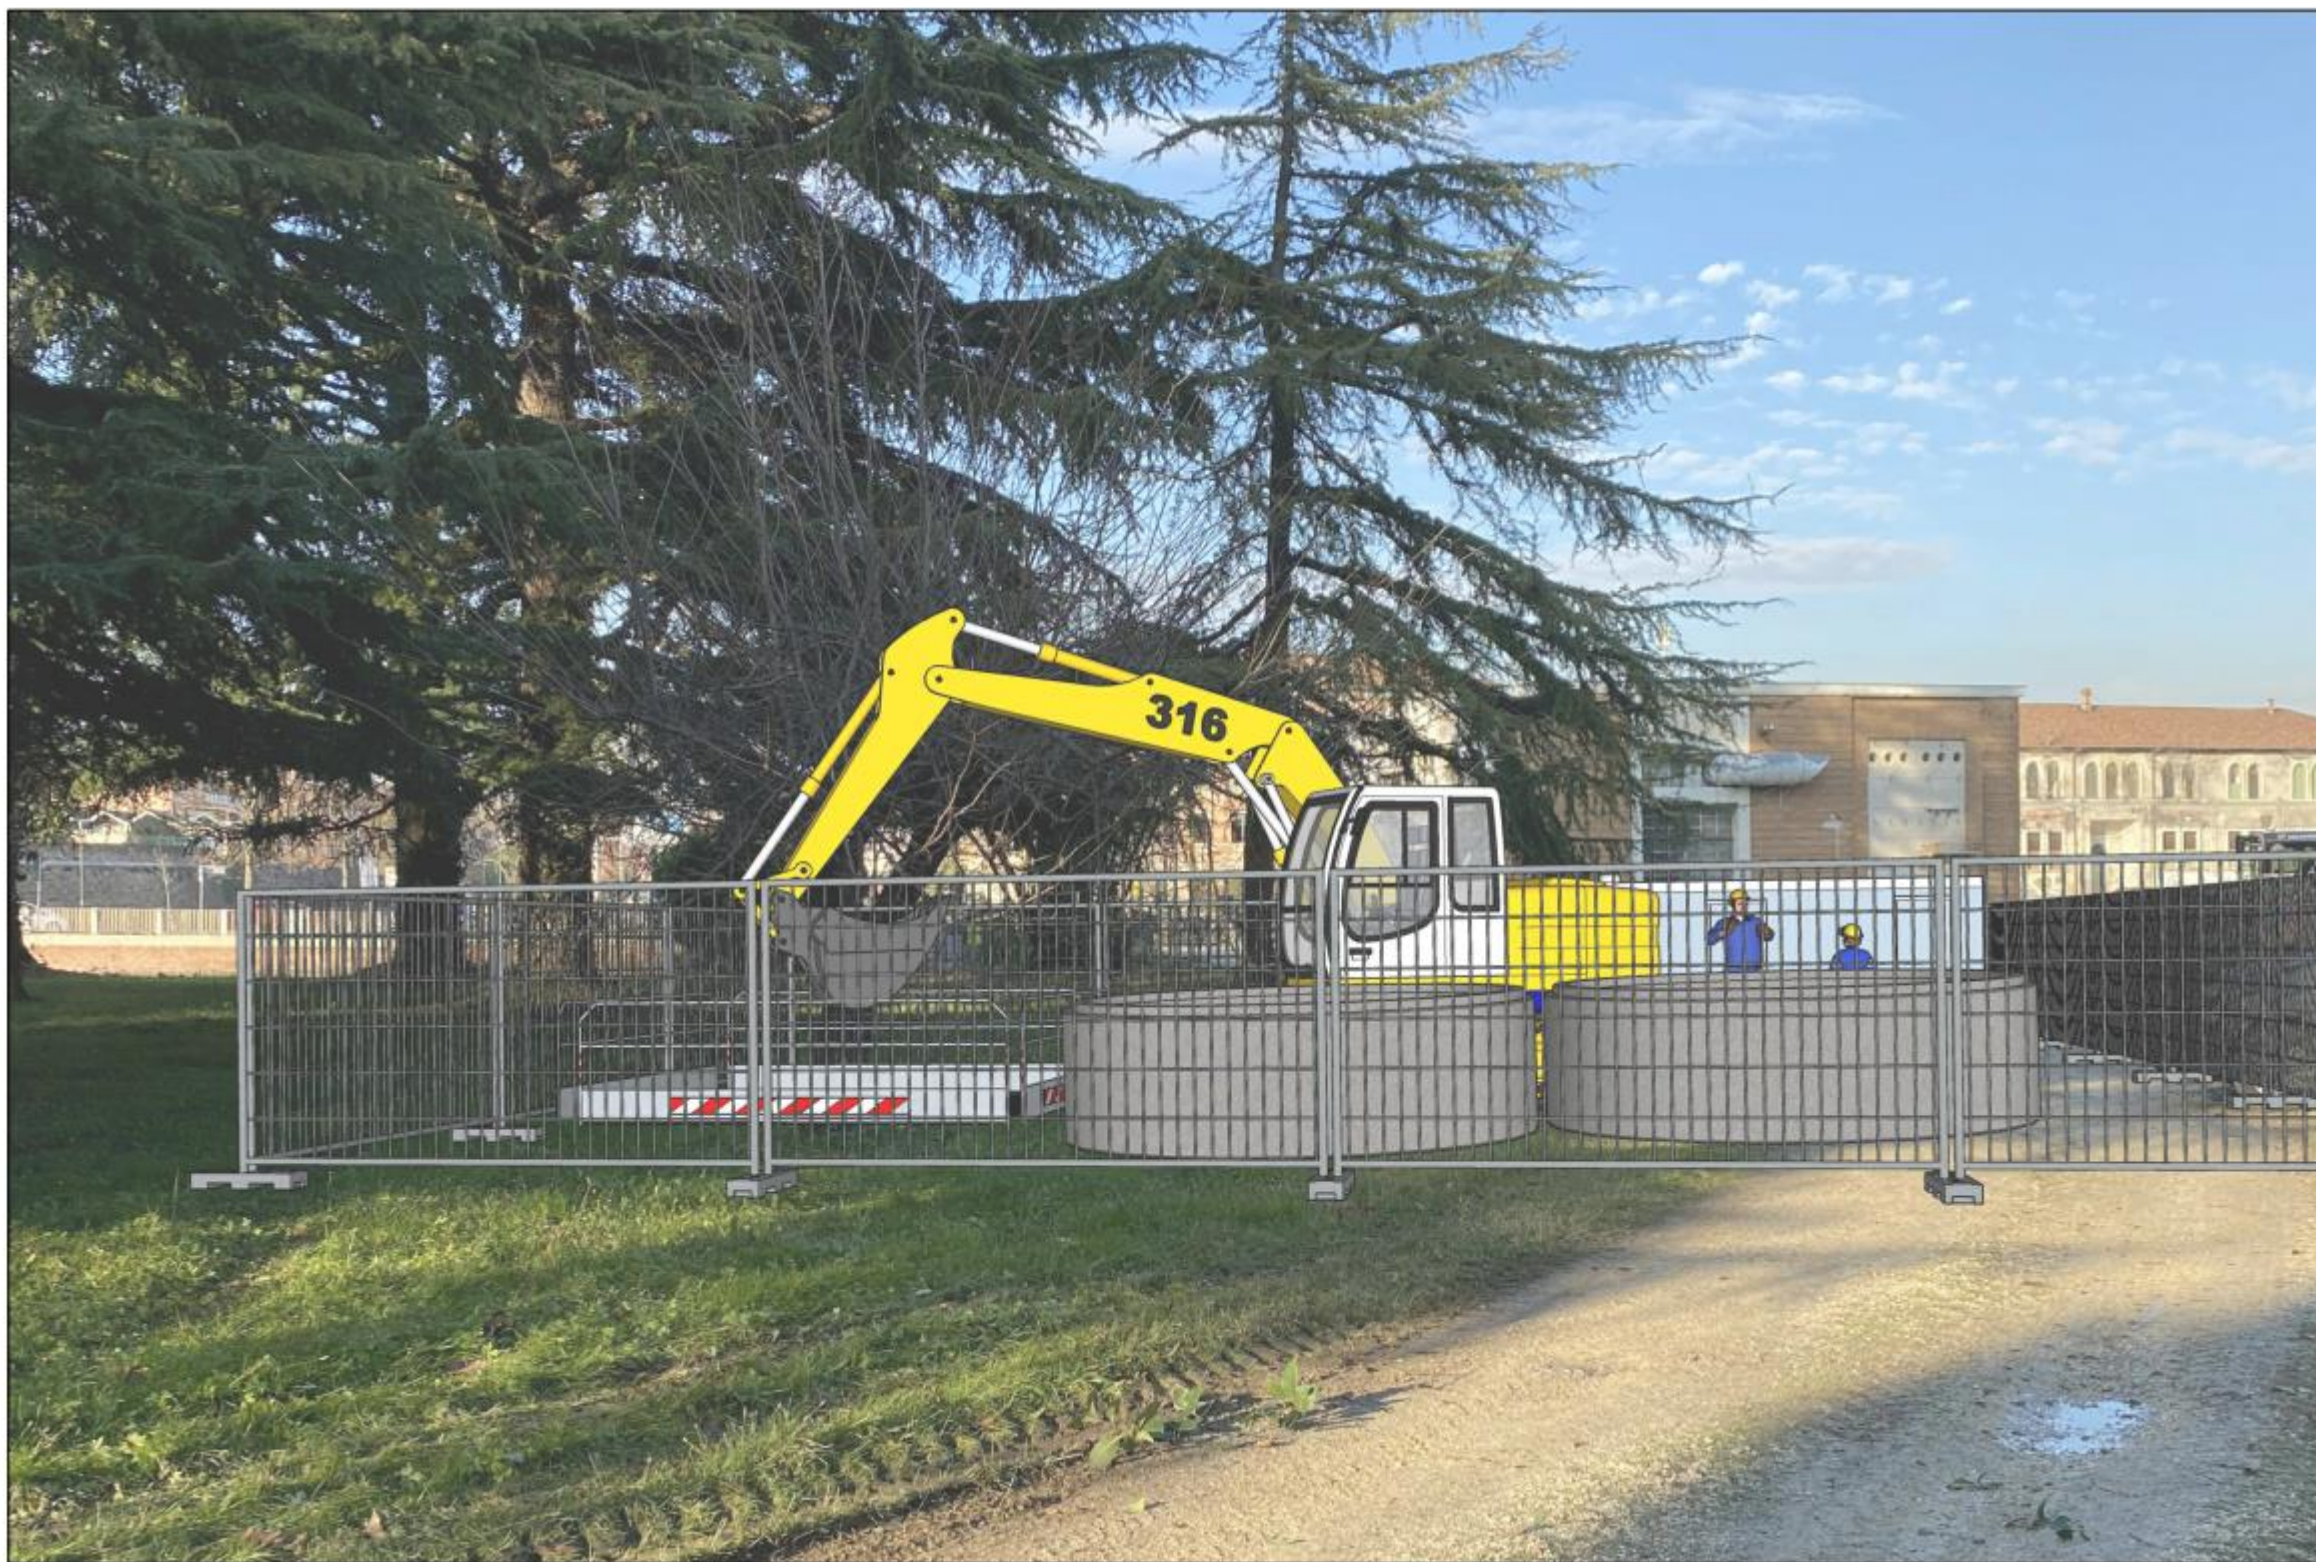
Q : Foto inserimento vista area cantiere POZZO S02a
